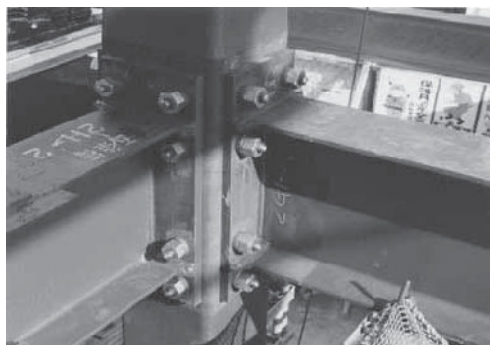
Exemplo de ligação viga/pilar com pilar oco e viga tipo IPE
